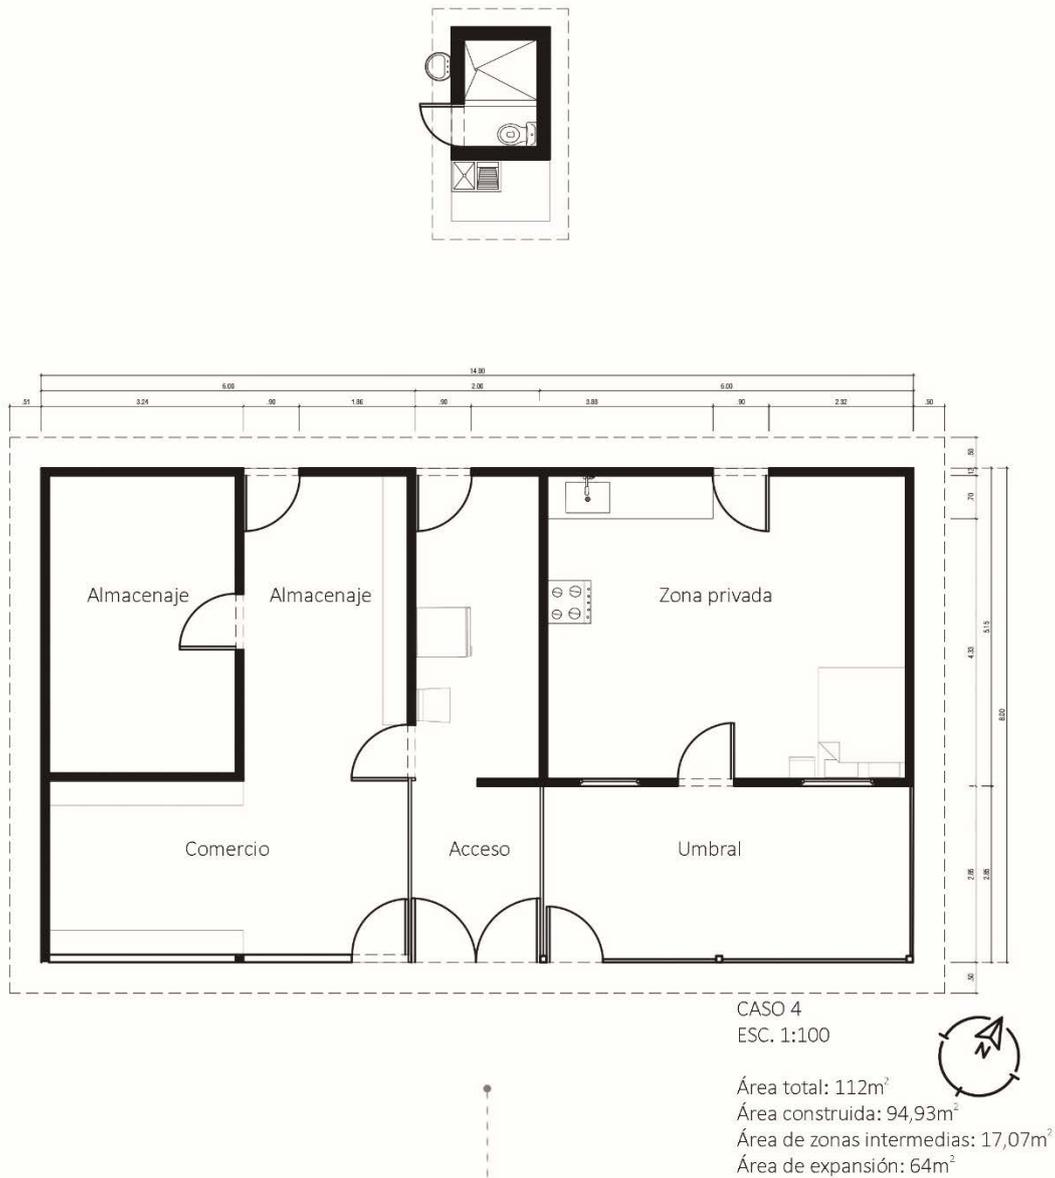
Planta caso 4. Esc. 1: 100. Fuente: Elaboración propia, con soporte en levantamiento planimétrico, (ETCR "Jaime Pardo Leal", San José del Guaviare, 5 ago. 2018)
